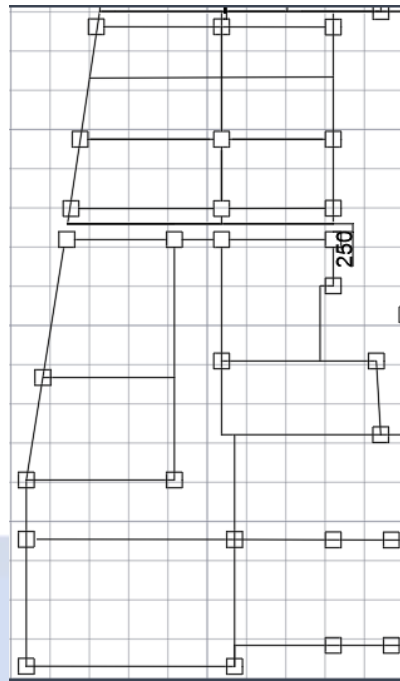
Jarak 250 mm Antara Bangunan B.1 dengan Bangunan B.2
